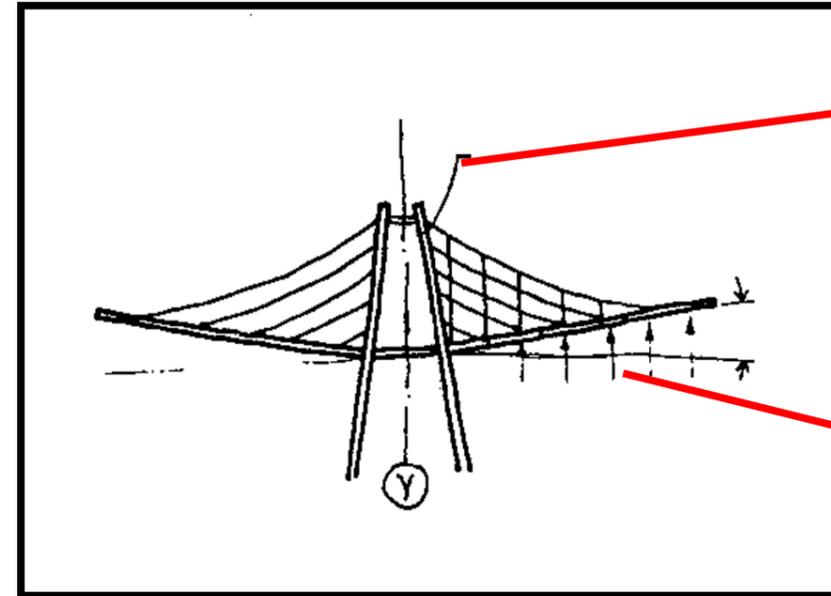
Estructura planimétrica, Coliseo, Fuente: Comprensión de las estructuras en arquitectura
